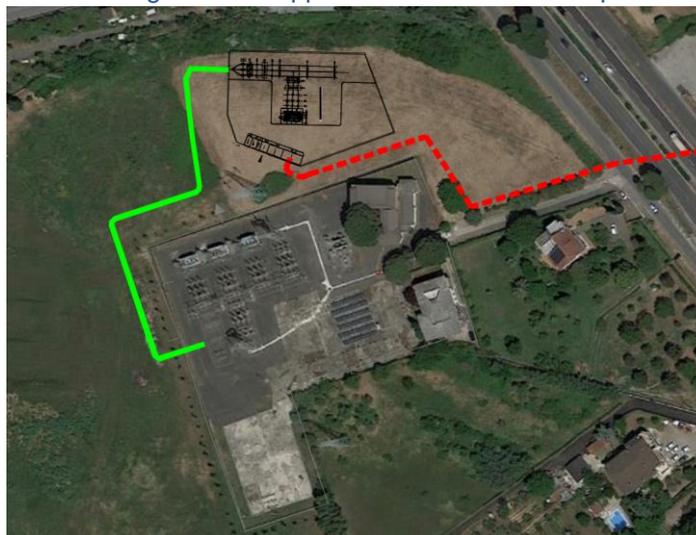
Step-Up con il collegamento in MT (in rosso) e il collegamento in AT dall'area di Step-Up alla cabina di e-distribuzione (in verde)
